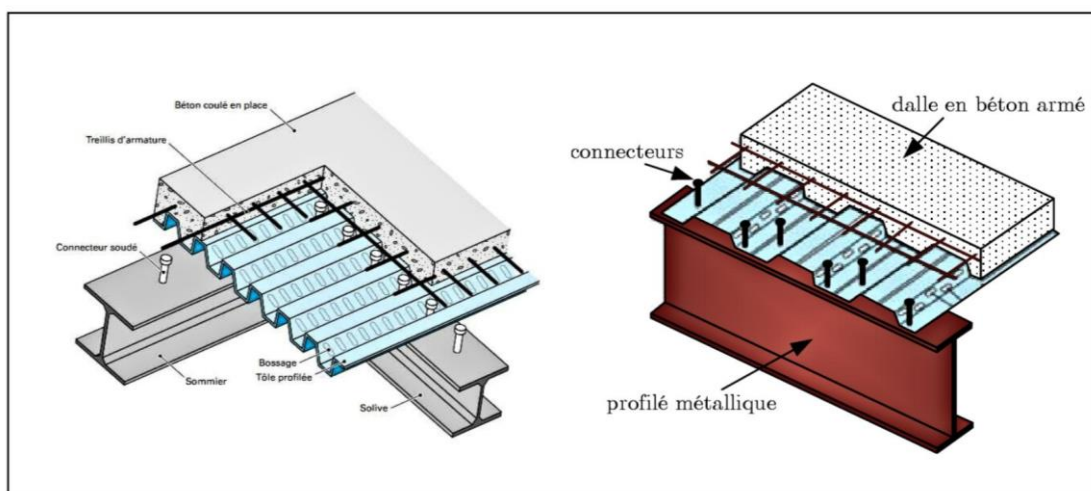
Coupes et détails techniques de la structure mixte béton-acier
